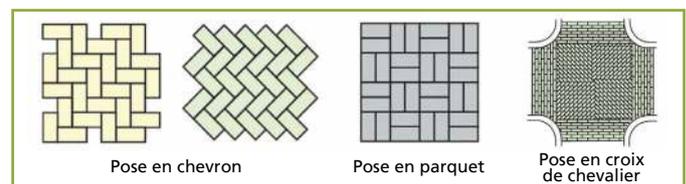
Exemples d'appareillages compatibles avec les produits en béton (source : Cérib, document 206.E)
